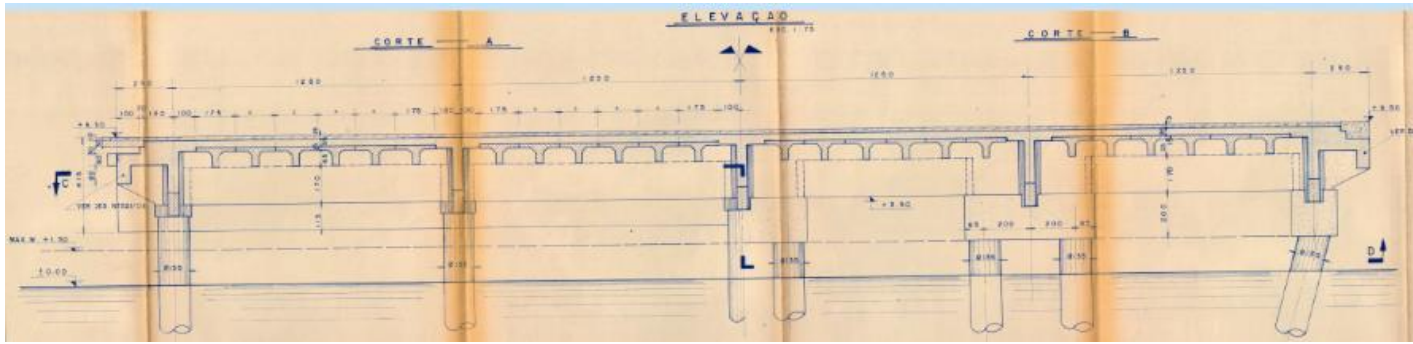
Corte longitudinal - formas da superestrutura no projeto original
